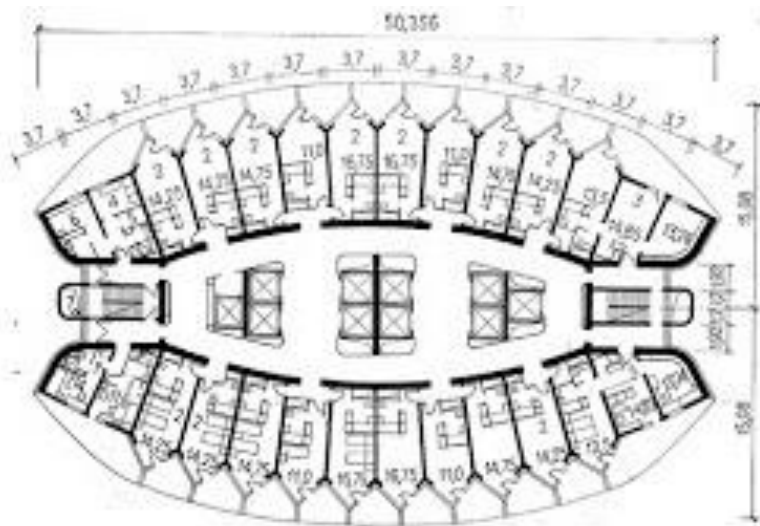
План житлового поверху готелю «Казахстан»
